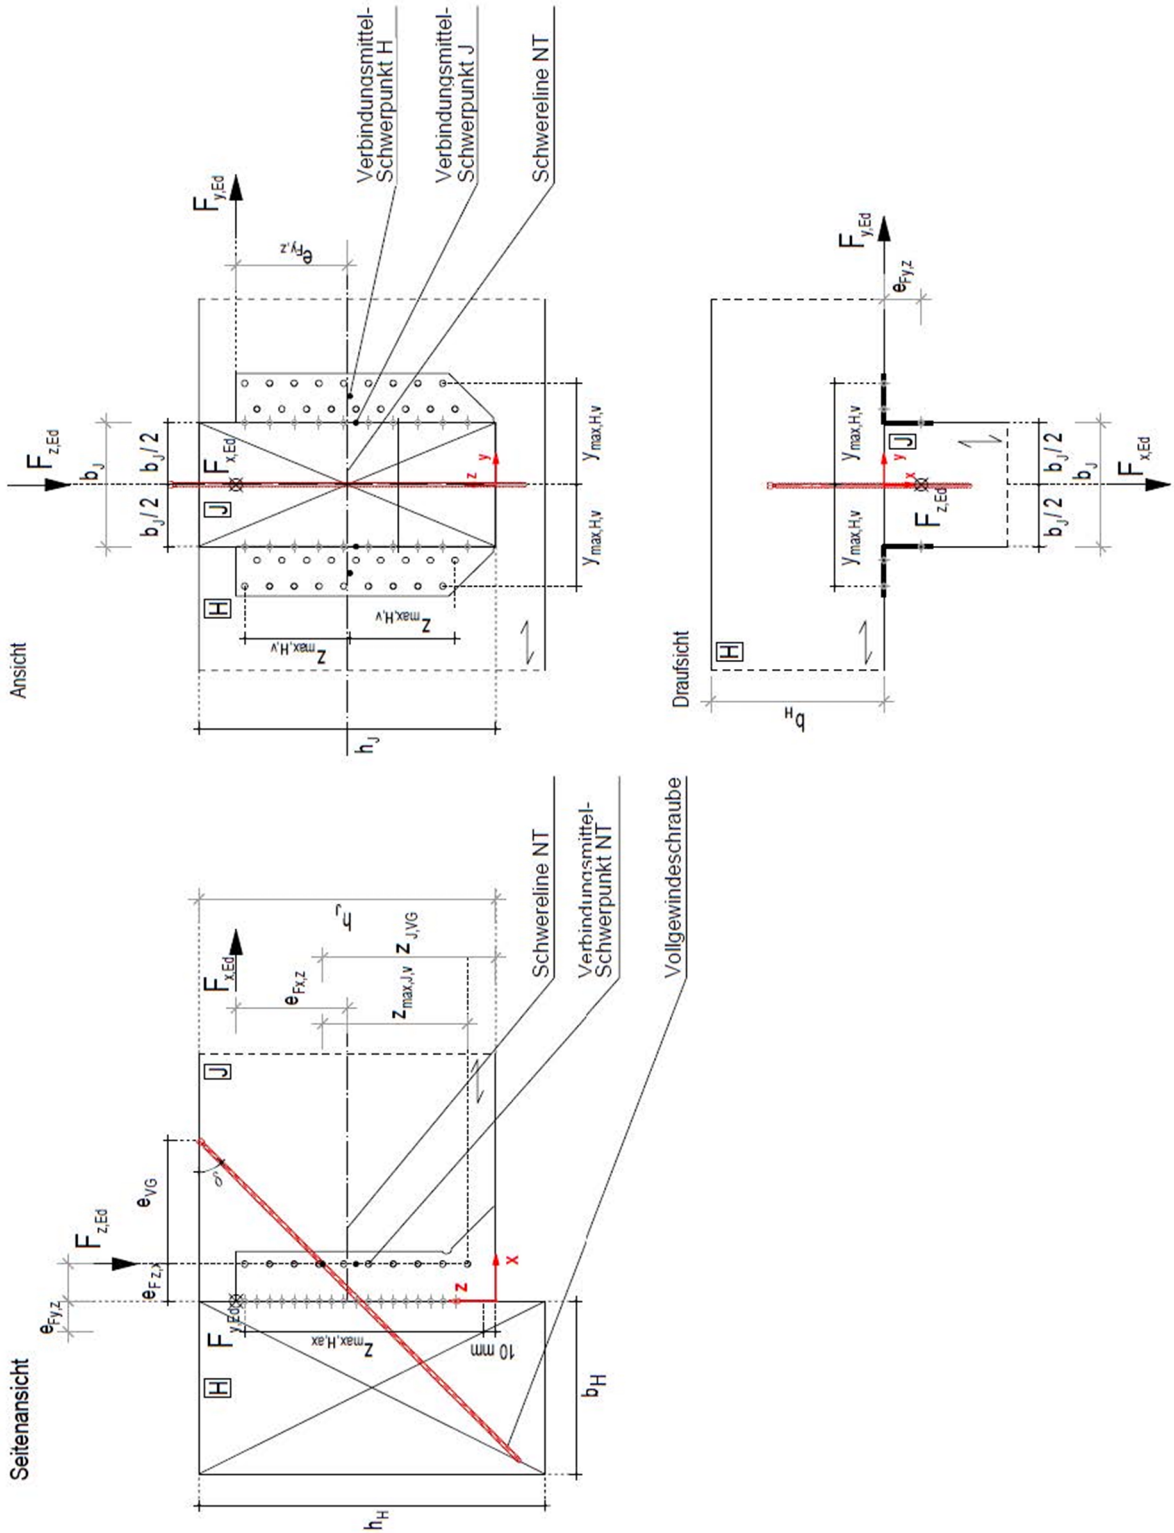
Schräge Schrauben für Kraft $F_{x,Ed}$
